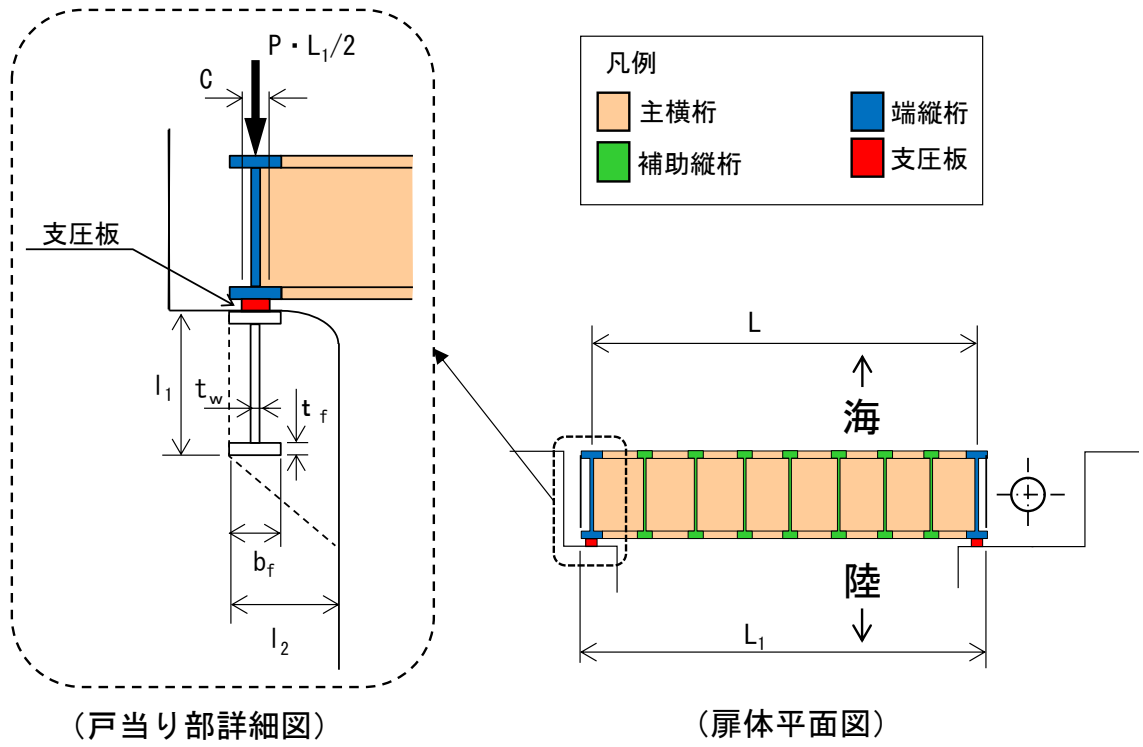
支圧板及び戸当り（腹板，底面フランジ，コンクリート）の評価イメージ図
